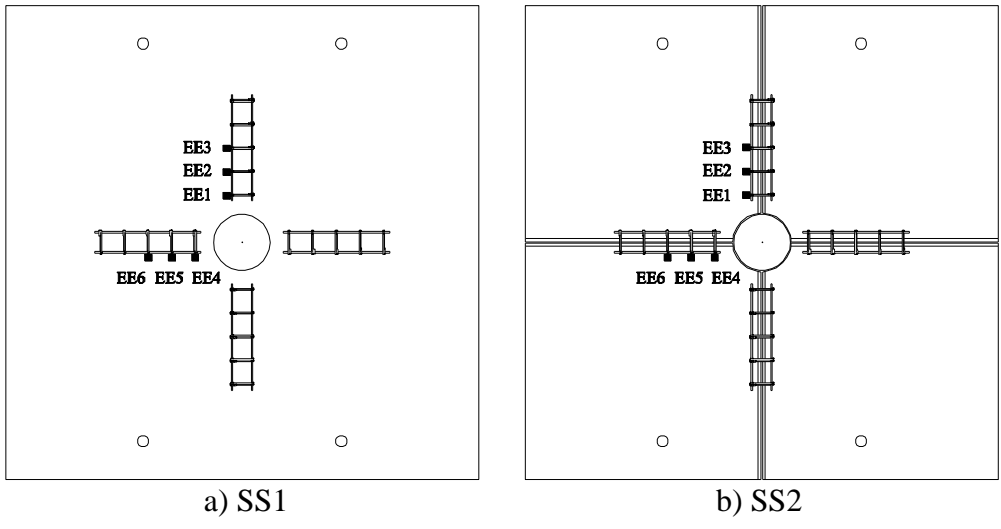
Posição dos extensômetros dos estribos (EE) – vista em planta
